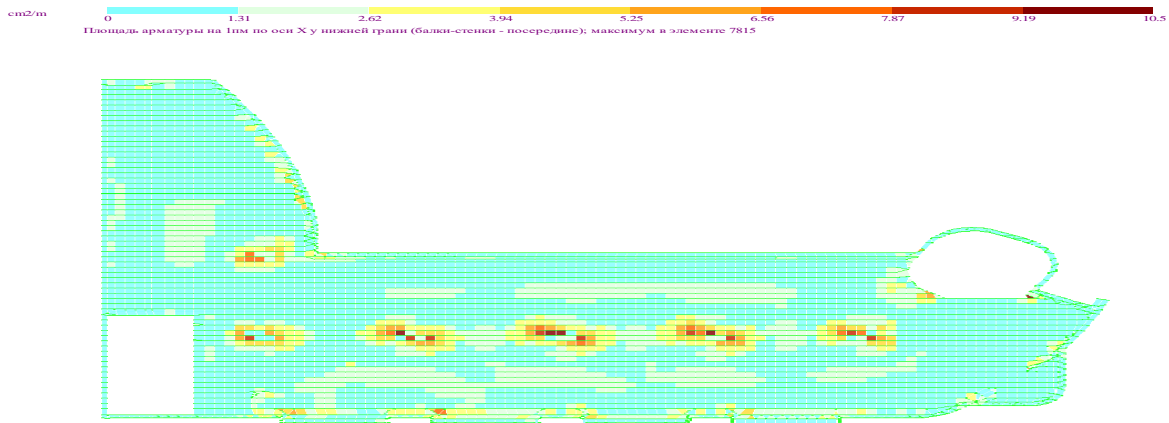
Клейонка армування нижньої арматури вздовж осі X для плити перекриття 1-го поверху
